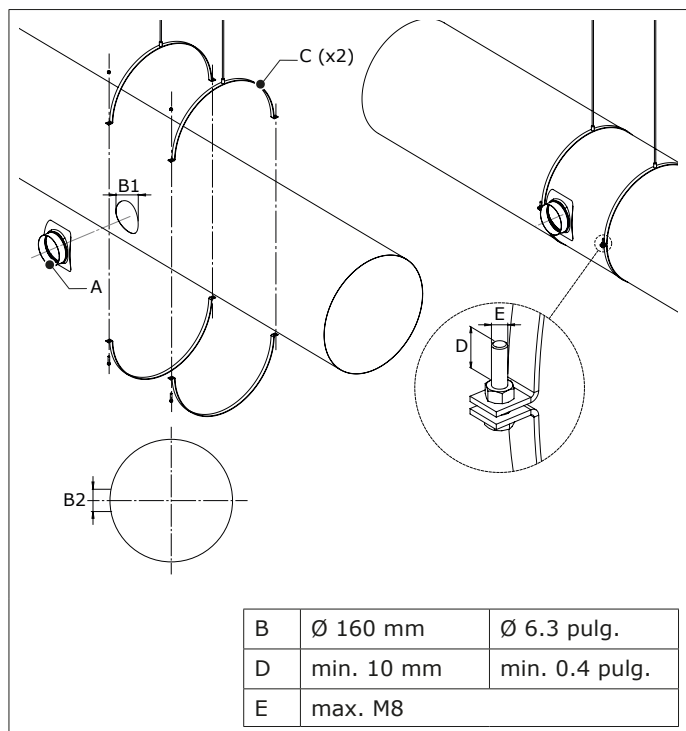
Montaje del soporte del conducto + pieza de injerto
